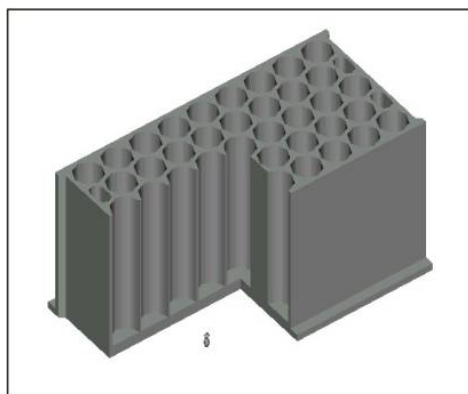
Croquis de un cajón flotante de hormigón armado.
